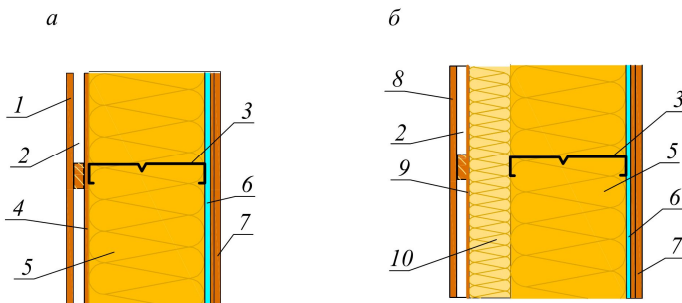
Конструкция наружной стены с деревянной рамой и рейками из листового стального профиля (а – с обшивкой гипсокартоном; б – с внешней консольной связью 25/50 мм): 1 – фасадная панель; 2 – 20 мм вентилируемого слоя; 3 – стальной профиль с шагом 0,6 м; 4 – обшивка из 9 мм гипсокартона; 5 – тепловая изоляция; 6 – пароизоляция; 7 – внутренняя обшивка; 8 – внешняя обшивка; 9 – обшивка; 10 – консольное присоединение негорючей тепловой изоляции, толщиной 25 мм
